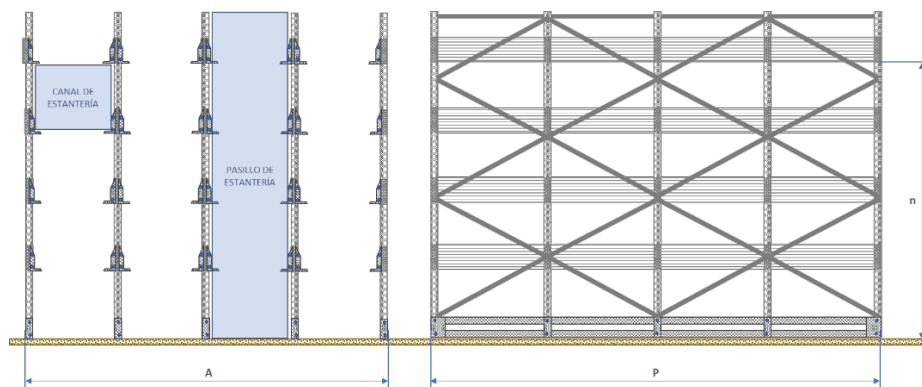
BLOQUE DE ESTANTERÍAS – COTAS PRINCIPALES
